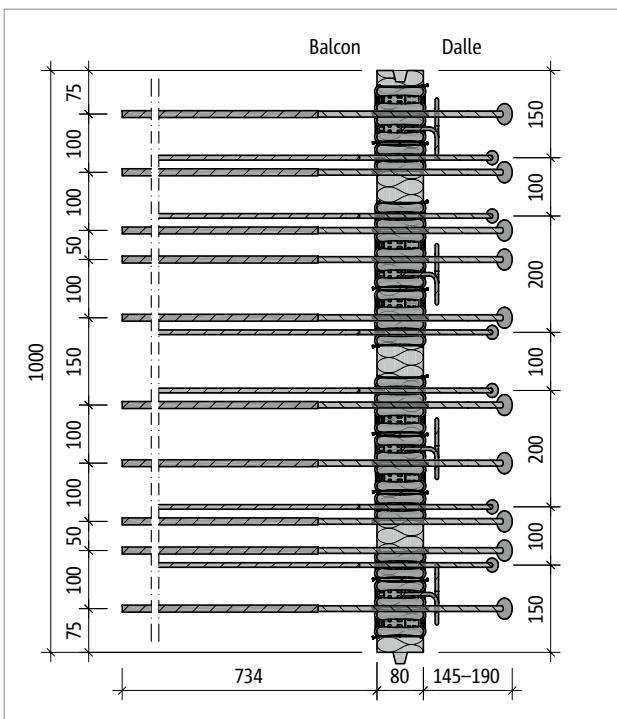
Schöck Isokorb® T type K-O-M4 : plan de base du produit
